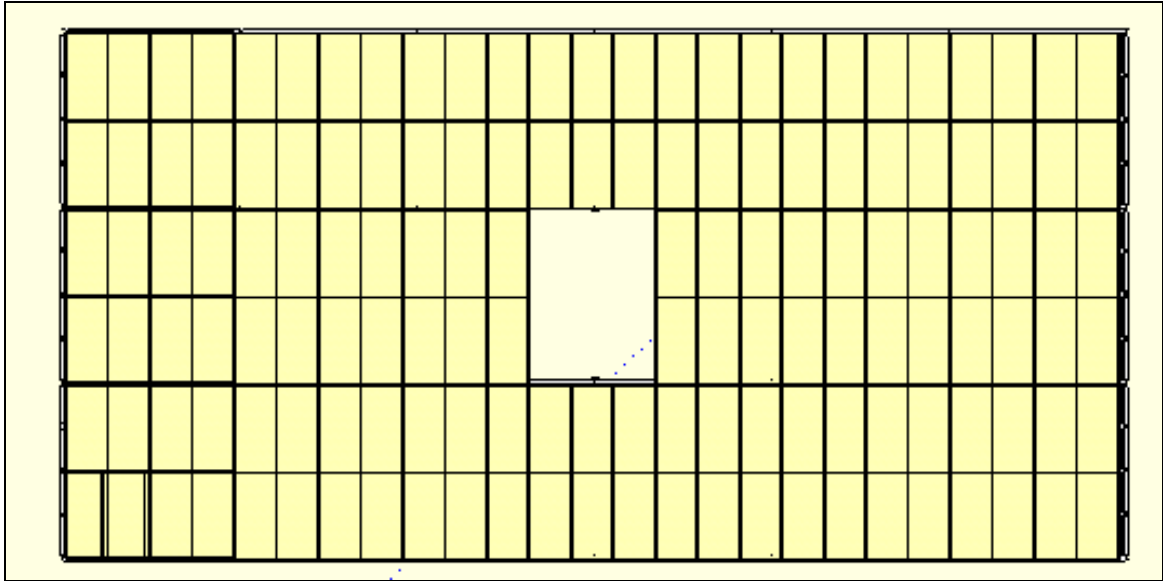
Paginação dos painéis Wall Wood na estrutura metálica
